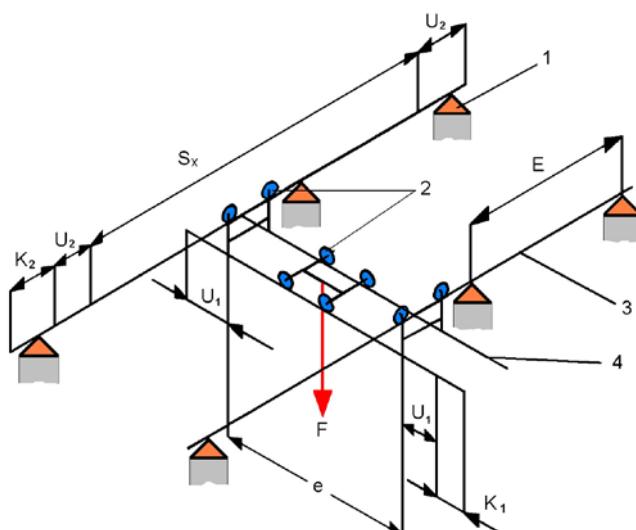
Portalfahrwerk mit Zweiträgerbrücke.
